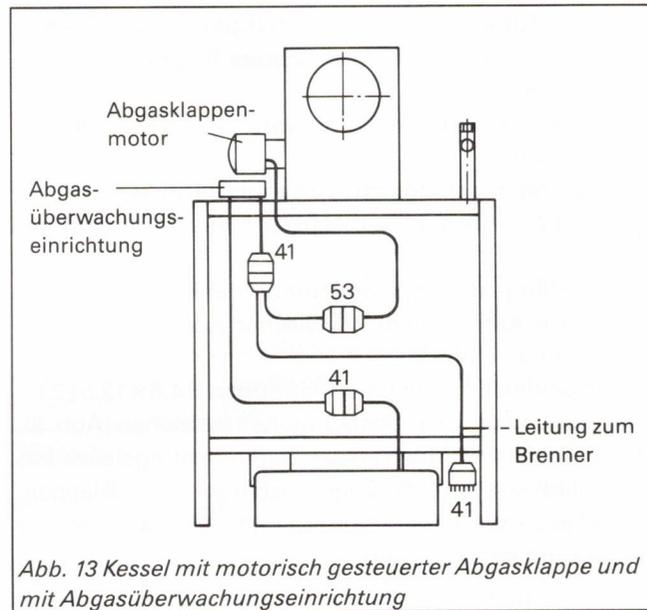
Kessel mit motorisch gesteuerter Abgasklappe und mit Abgasüberwachungseinrichtung
